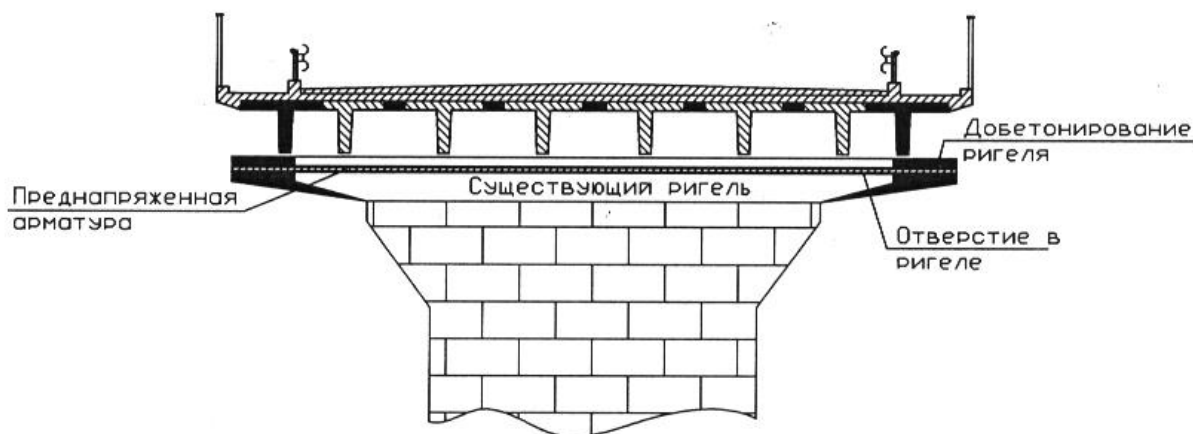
Уширение ригеля с армированием его преднапряженной арматурой, расположенной в буроканалах
